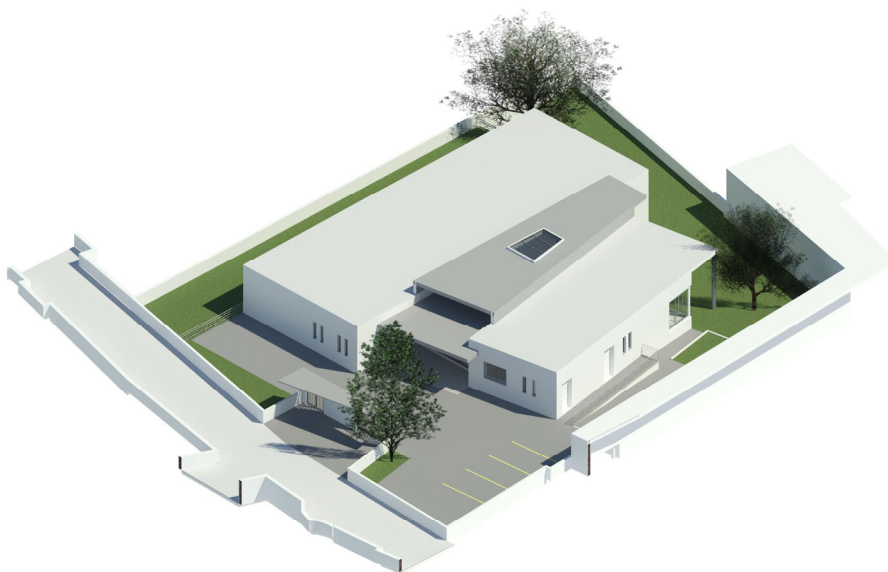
Vista di progetto – Prospetti Ovest e Sud
